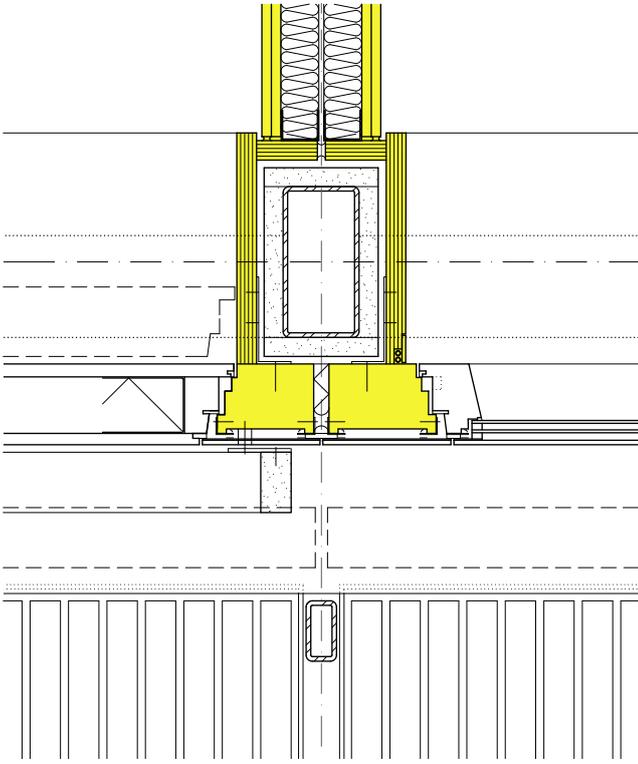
Stützenabstand 1,35 m mit Stahlstützen 100 x 200 mm, incl. Brandschutzverkleidung, Trennwand- und Fassadenanschluss: unökonomische Variante durch sehr enge Stützenstellung, die dem Gedanken des Holzbaus widerspricht, jedoch schalentegekoppelte Wandanschlüsse in allen Achsen möglich und dadurch keine Flexibilitätseinschränkungen, filigrane Ausbildung der Fassade möglich.
